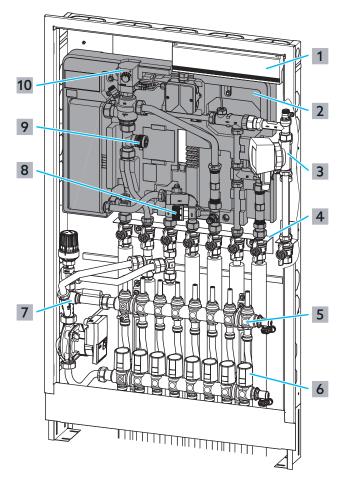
Exemple d'installation avec coffret, bouclage d'E.C.S. et surface chauffante
